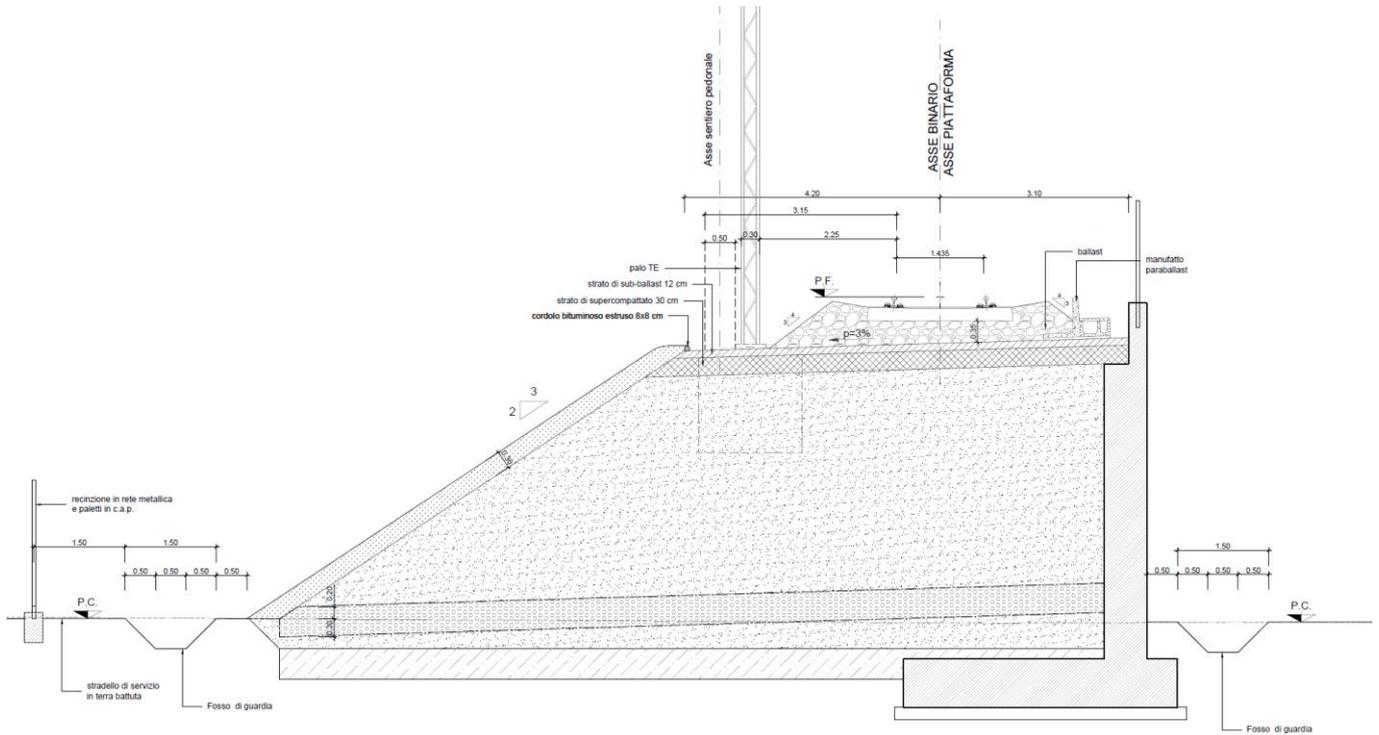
Sezione tipo a singolo binario in rilevato con muro in sezione ridotta
